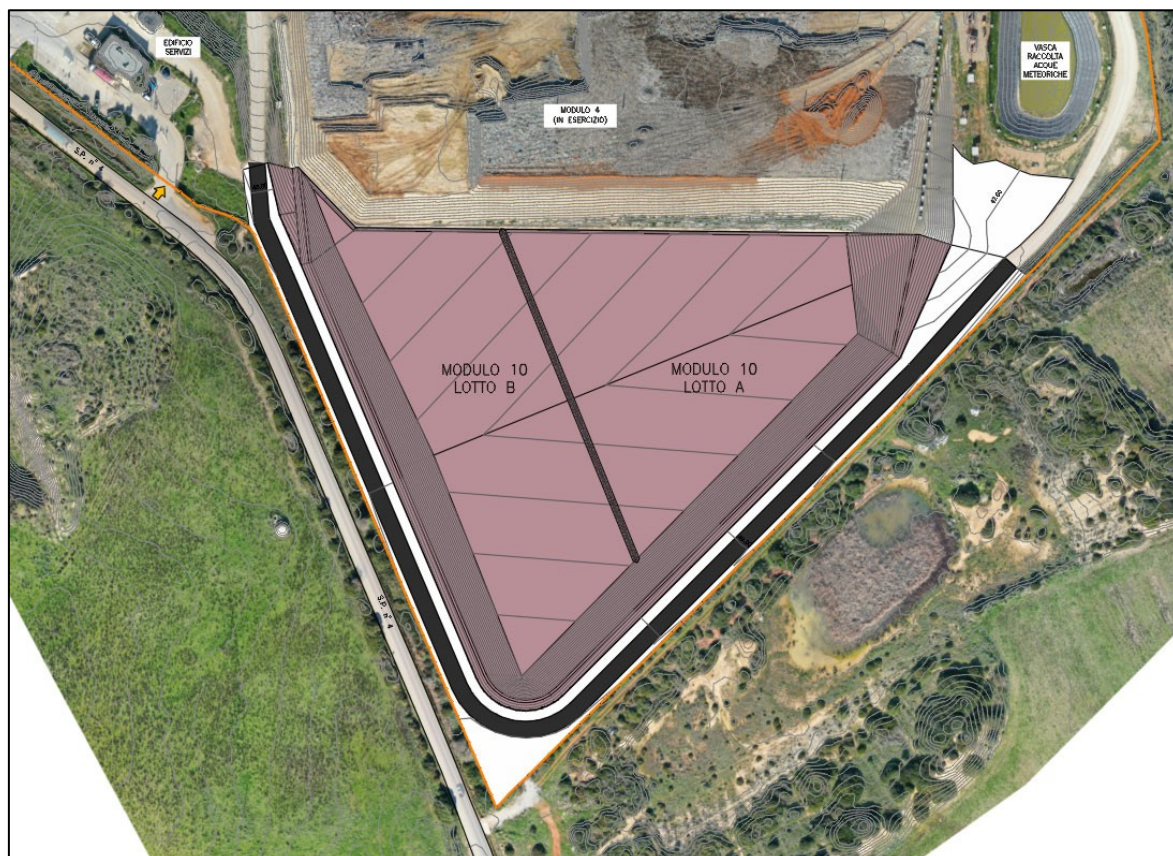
/B: Planimetria Modulo 10 Il progetto prevede un volume di stoccaggio pari a circa 330.000 mc.
